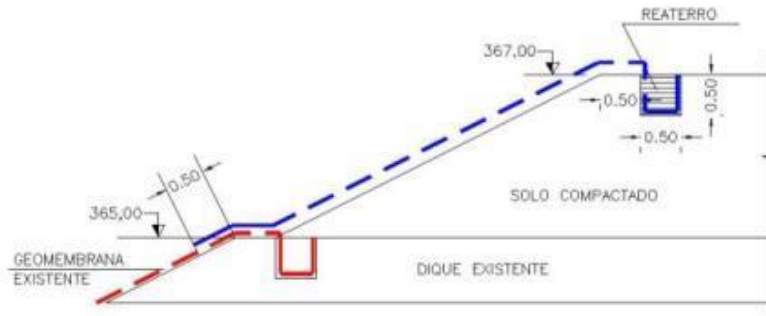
Detalhe de sobreposição de geomembrana existente com nova a ser instalada
